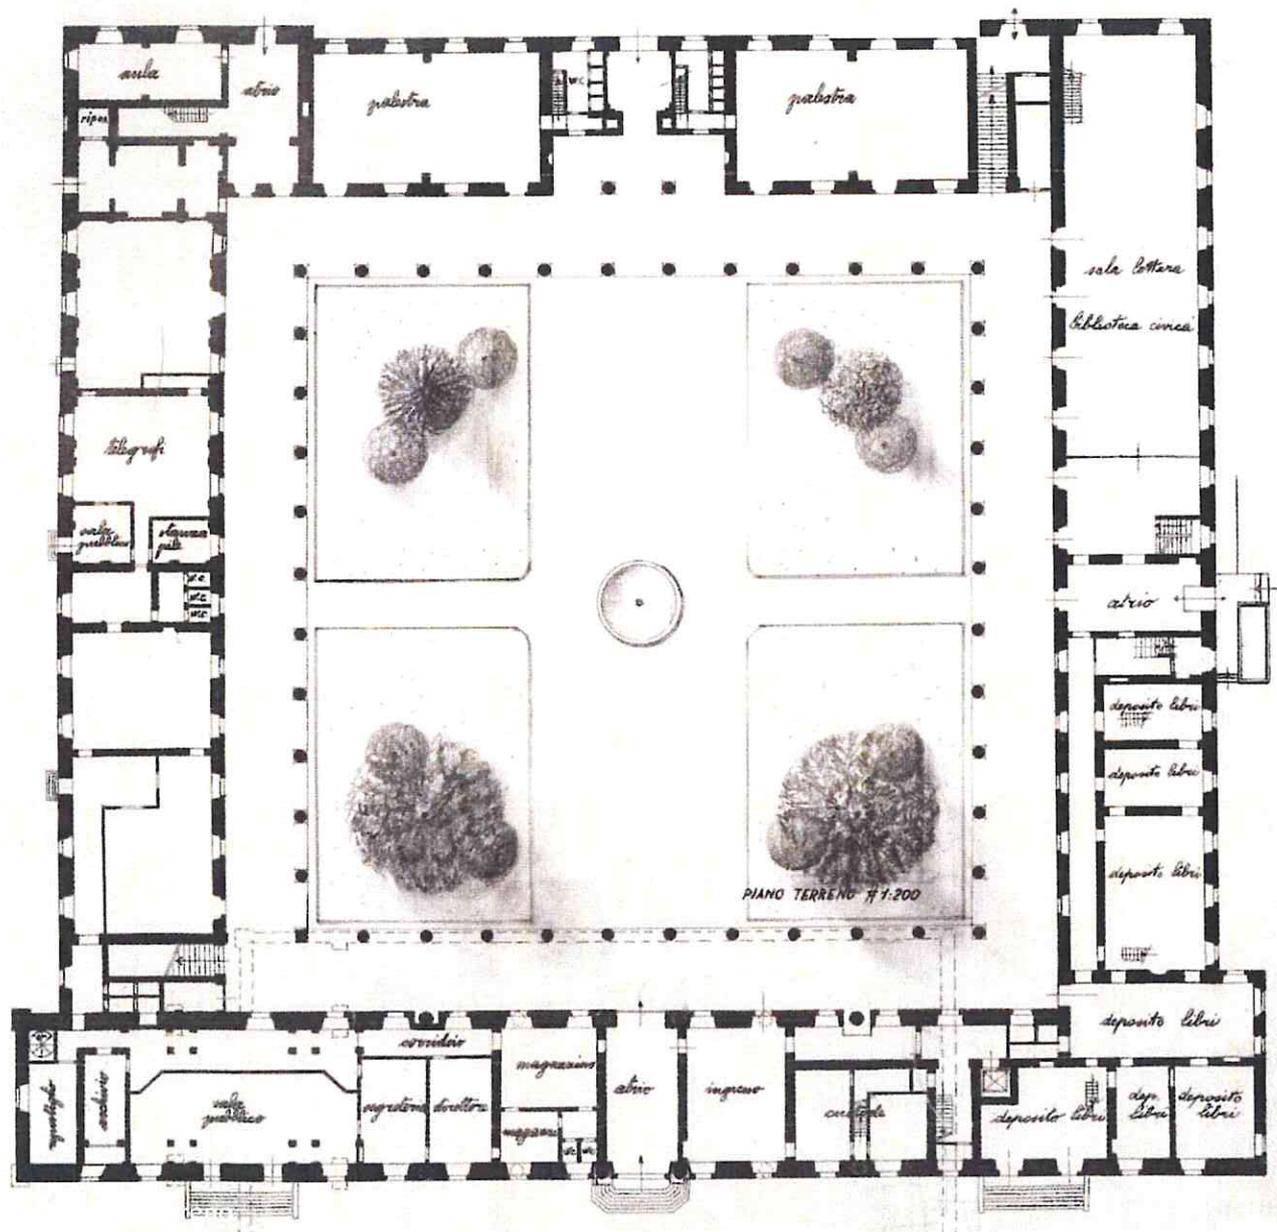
\_Planimetria piano terra del Palazzo degli Studi risalente al 1980
